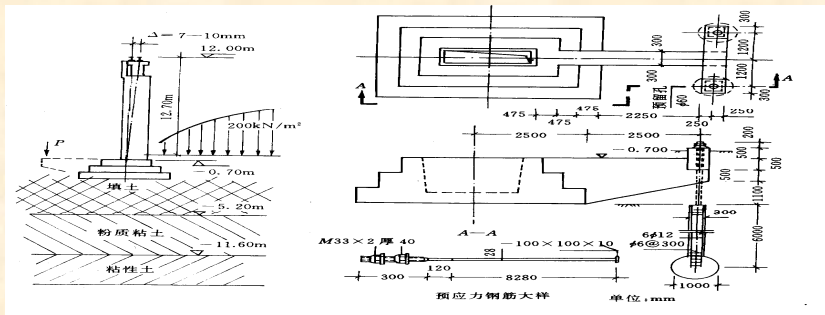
露天跨工程柱基及主倾斜情况和基础加压纠偏示意
